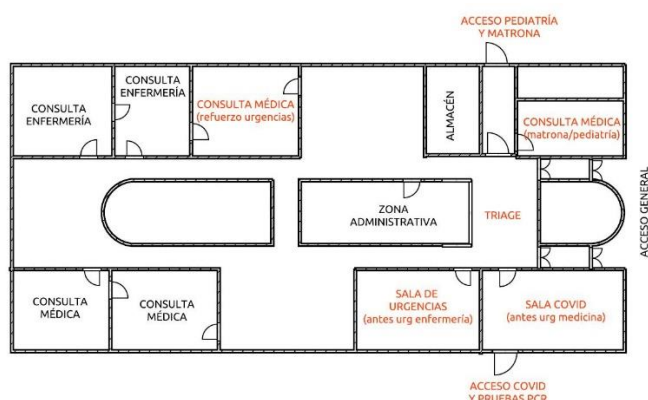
Plano con la distribución y organización del centro de salud de Santa Olalla.
